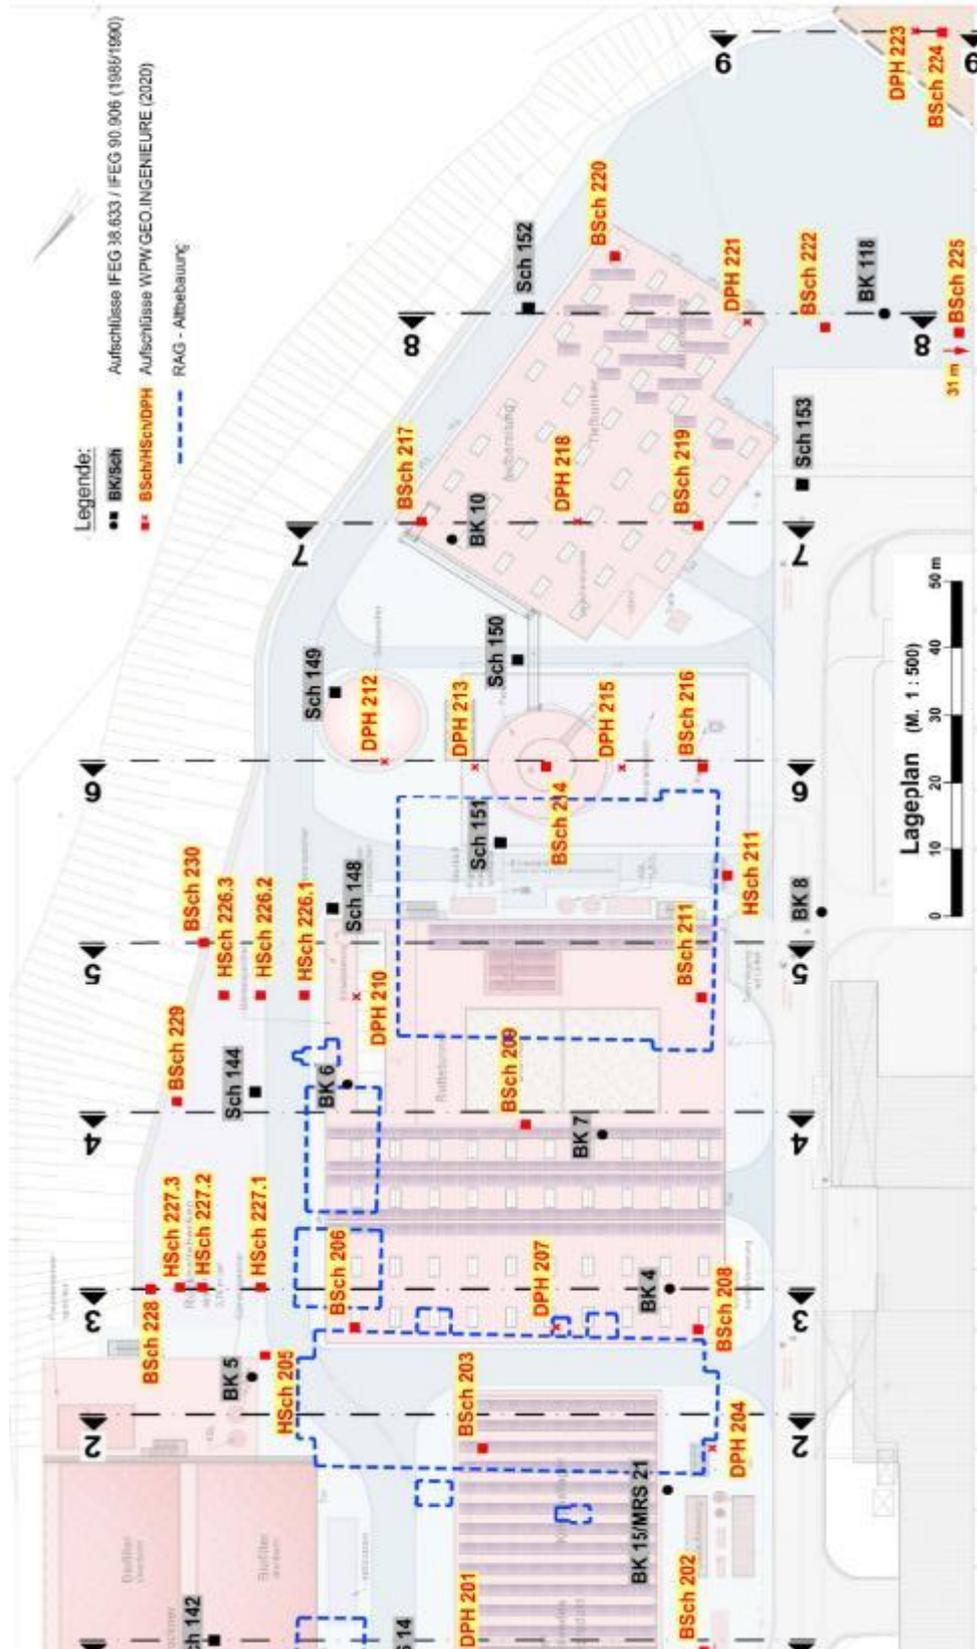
Übersichtslageplan - Baugrunduntersuchung 1/2
